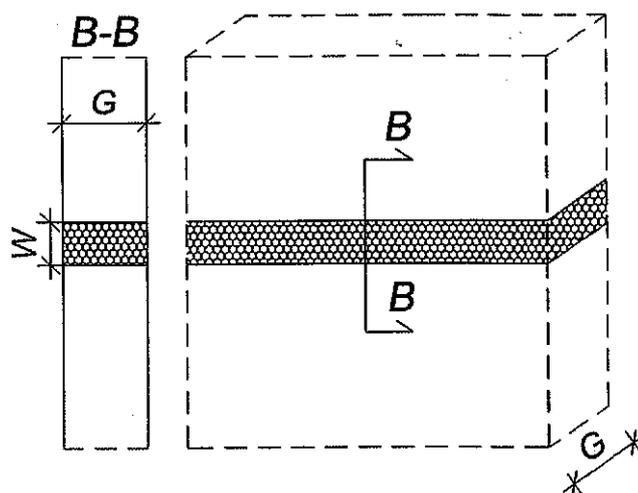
Proiezione e sezione del giunto lineare orizzontale nel muro
